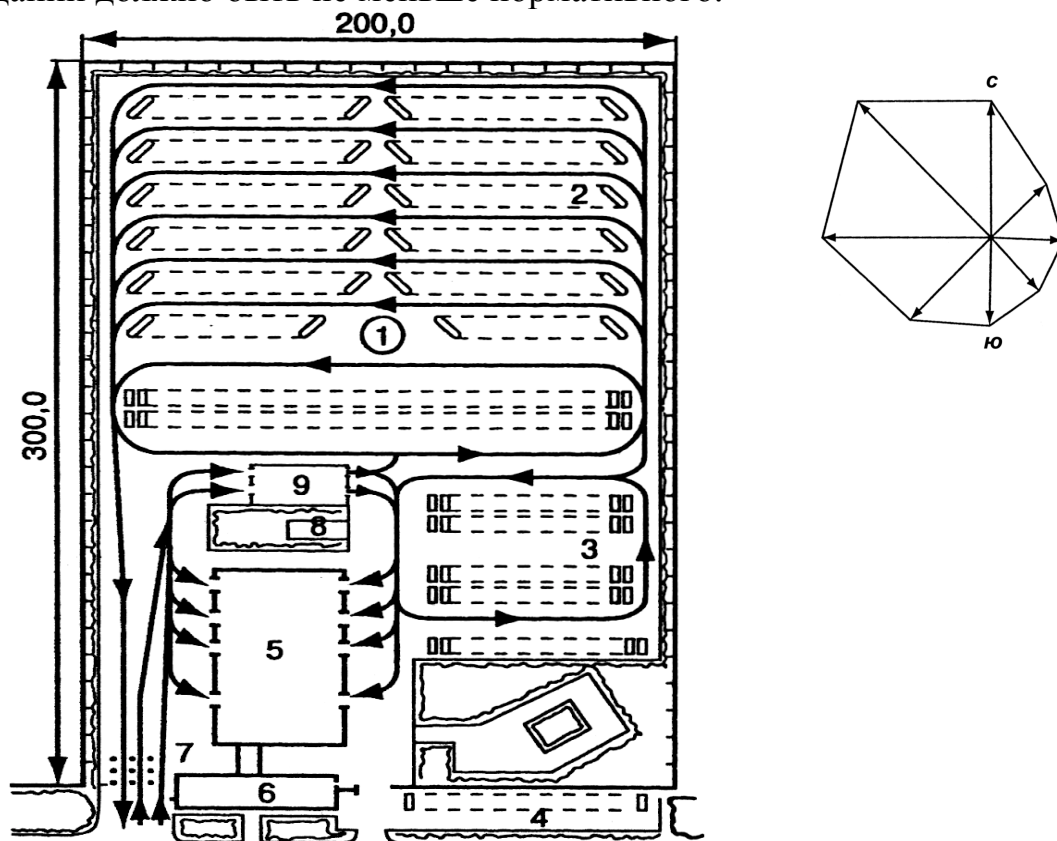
Генеральный план автотранспортного предприятия на 450 грузовых автомобилей: 1 – резервуар противопожарного запаса воды; 2 – открытая площадка зоны хранения автопоездов; 3 – открытая площадка зоны хранения единичных автомобилей; 4 – стоянка легковых автомобилей; 5 – производственный корпус; 6 – административно-бытовой корпус; 7 – контрольно-пропускной пункт; 8 – очистные сооружения с обратным водоснабжением; 9 – корпус ежедневного обслуживания
